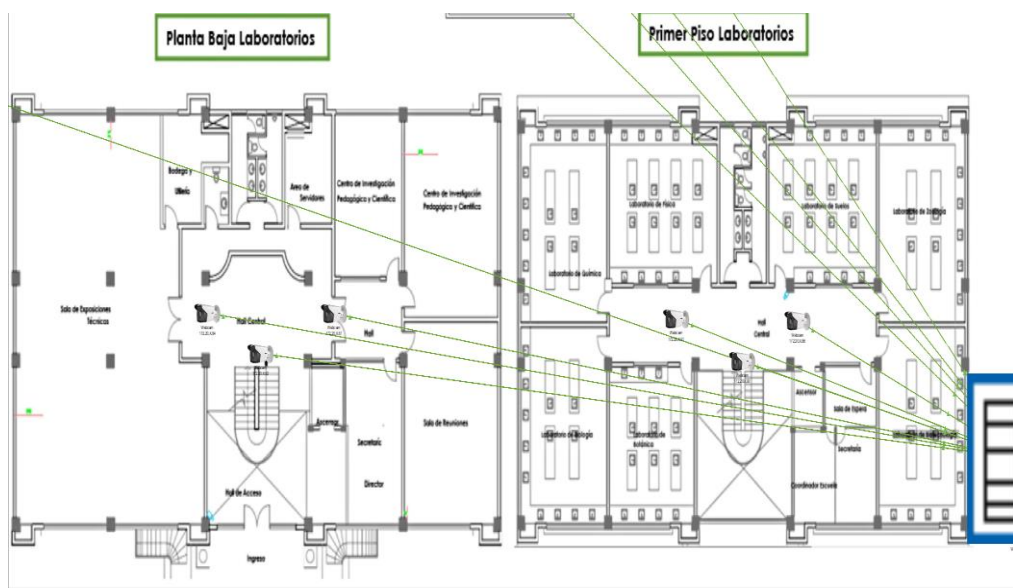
Cámaras en el Edificio Laboratorios Planta Baja y Primer Piso.
